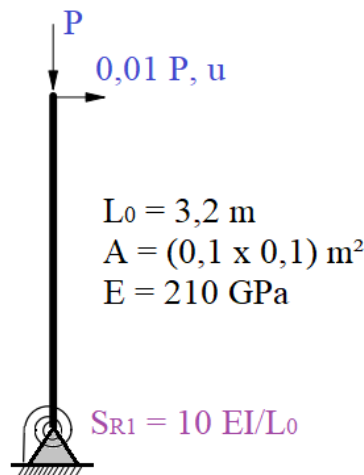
Modelo estrutural do pilar com apoio semirrígido.
